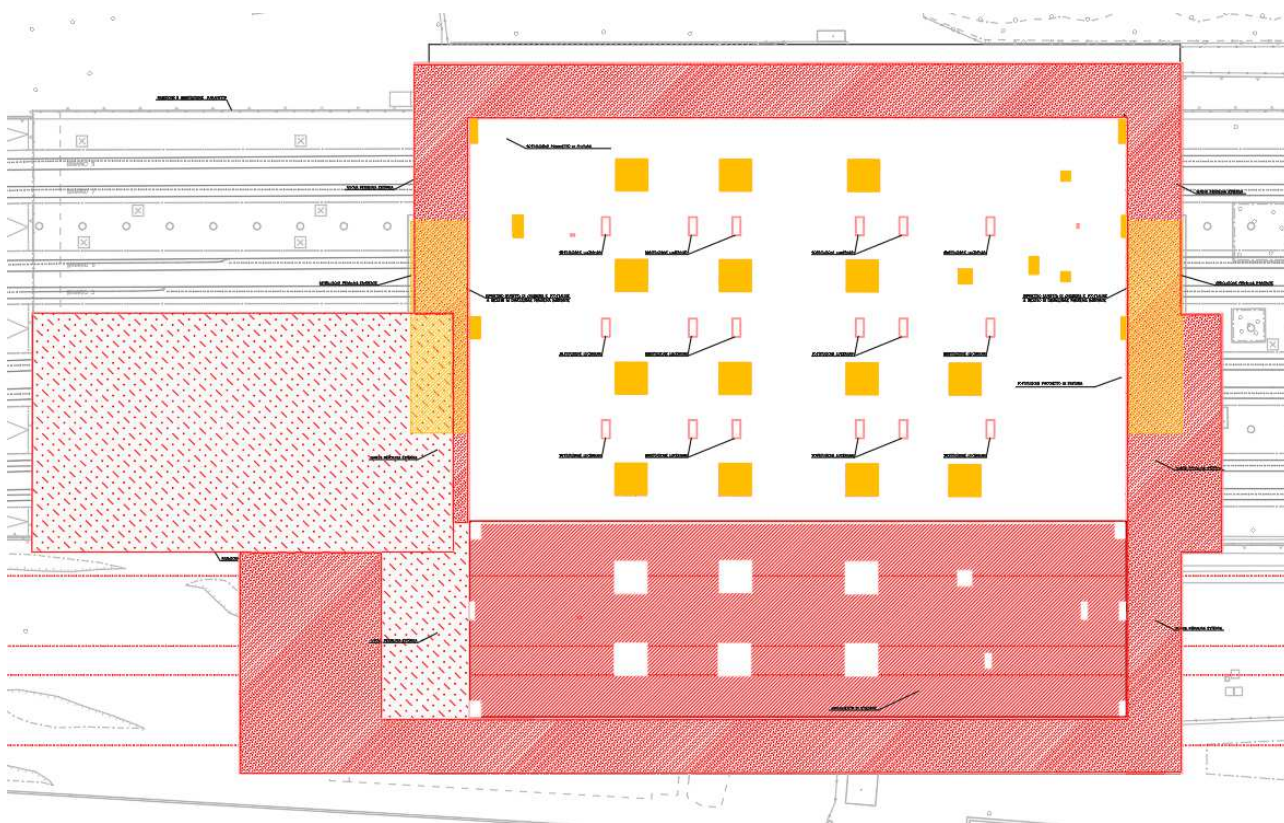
Planimetria demolizioni Piano Coperture Stazione di Bovisa (demolizioni in giallo)
